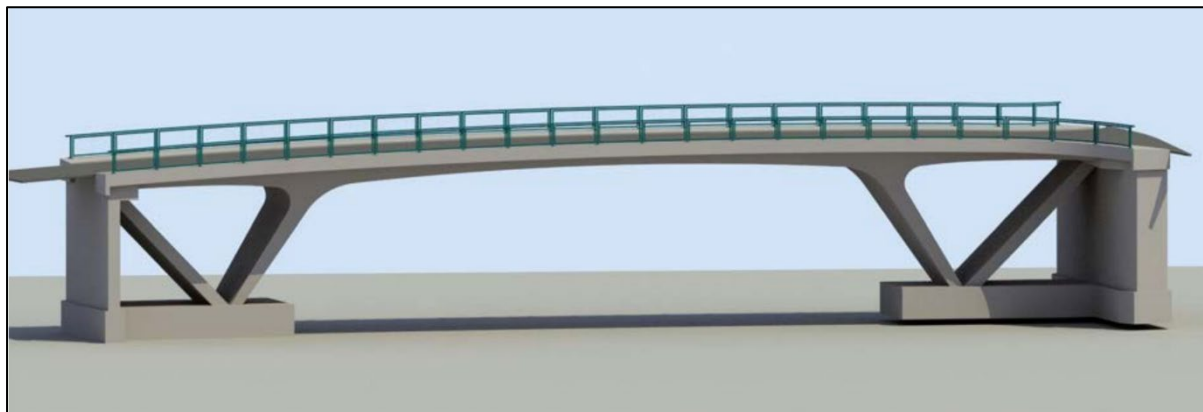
3D-Modell der tragenden Konstruktion [Fuchs, M. et al: Neubau einer integralen Spannbetonbrücke, Beton- und Stahlbetonbau 112, Sonderdruck Februar 2017]
